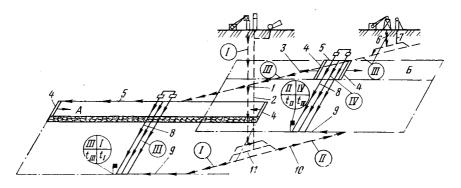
Вариант схемы строительства шахт группы II с этажной схемой подготовки пластов и разработкой этажей по пласту:
